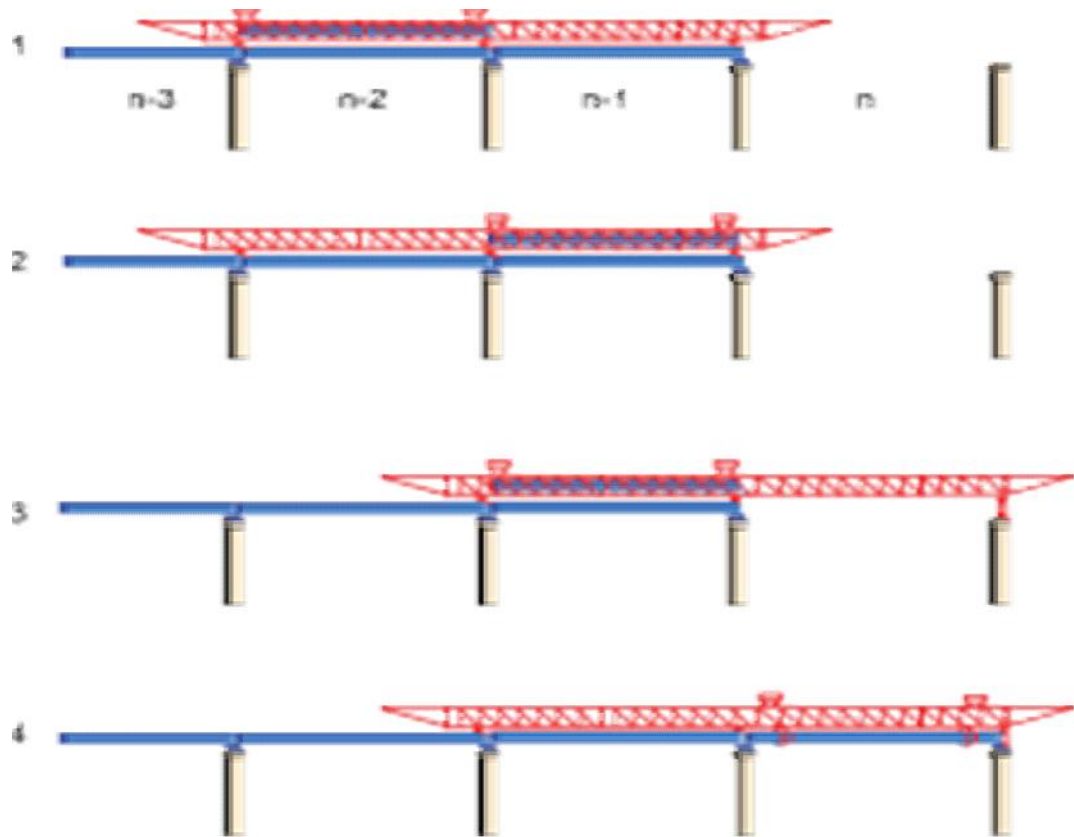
Les quatre étapes d'une construction d'un pont à poutres par préfabrication puis lançage à l'aide d'un cintre lanceur.
